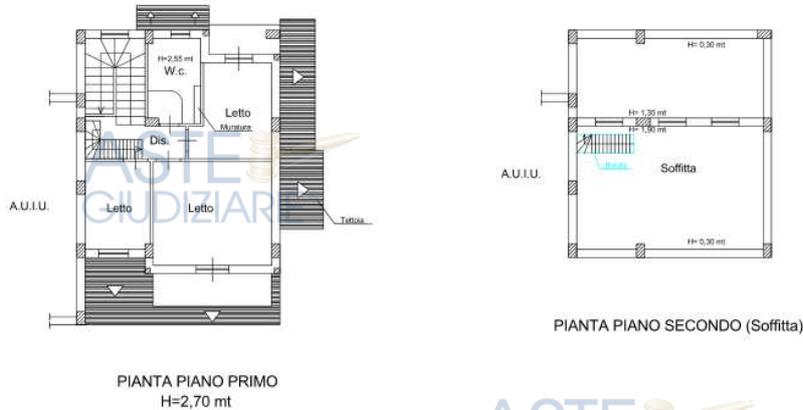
PLANIMETRIE RILEVATE STATO ATTUALE (vedi foto immobile in allegato)
